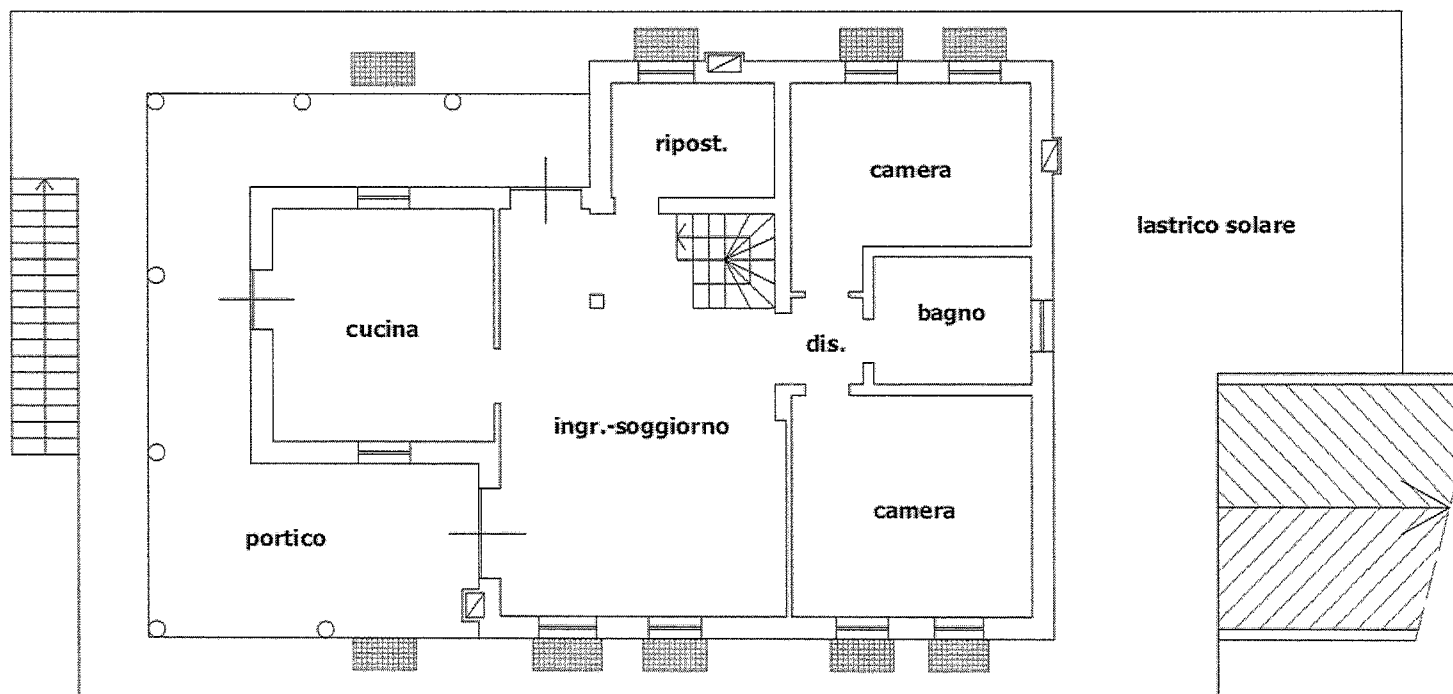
pianta piano terra STATO ATTUALE (fuori scala)
